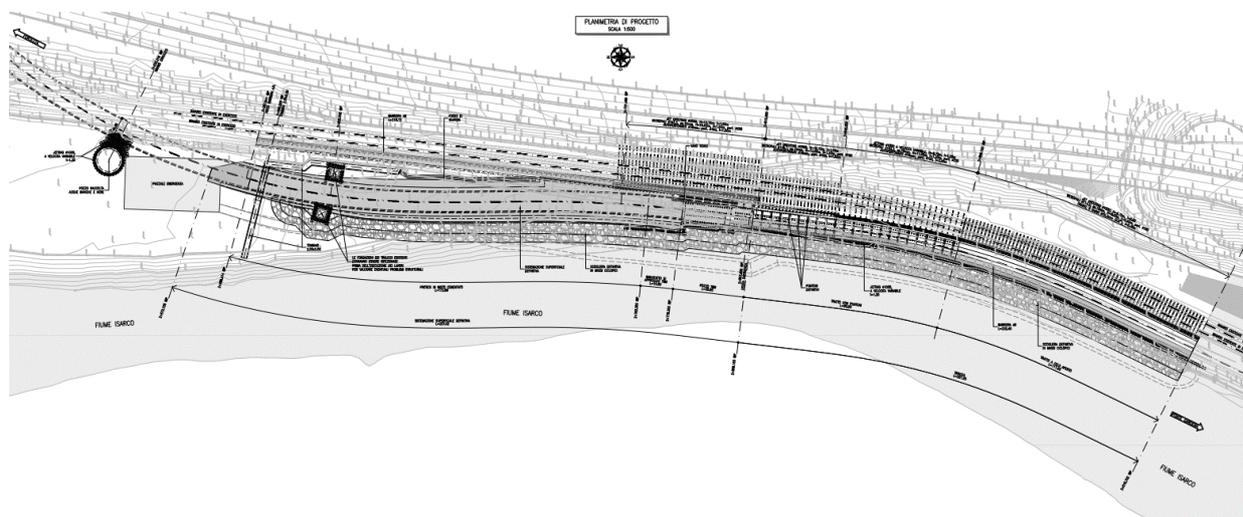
Planimetria di progetto dello stato finale delle opere di imbocco della galleria di interconnessione binario pari.
